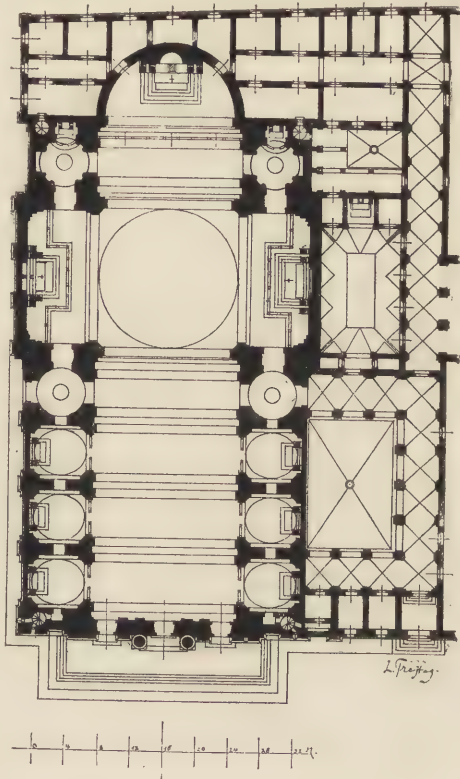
Il Gesù zu Rom, Grundriss.
